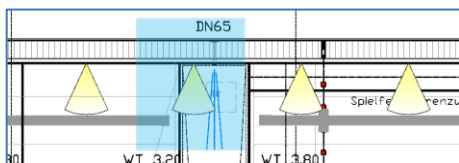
2.4.33 2021-10-22 905 472 Wassertechnik Grundriss E-2 Aufstellplan
